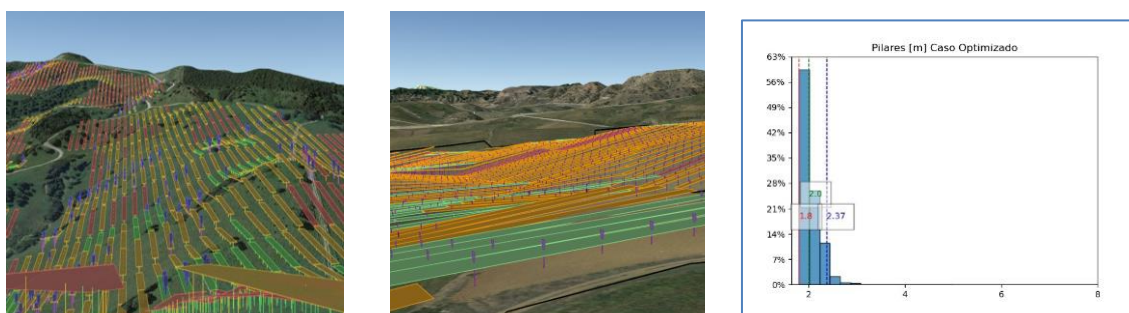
Modelización 3D de la planta e histograma de alturas de pilar
